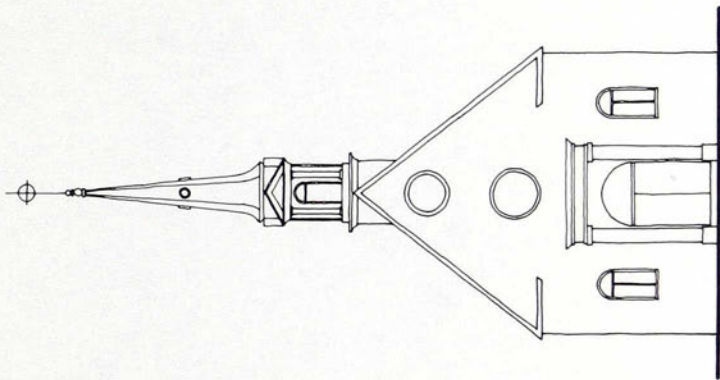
Dessin de la façade après la construction du clocher en 1861.
